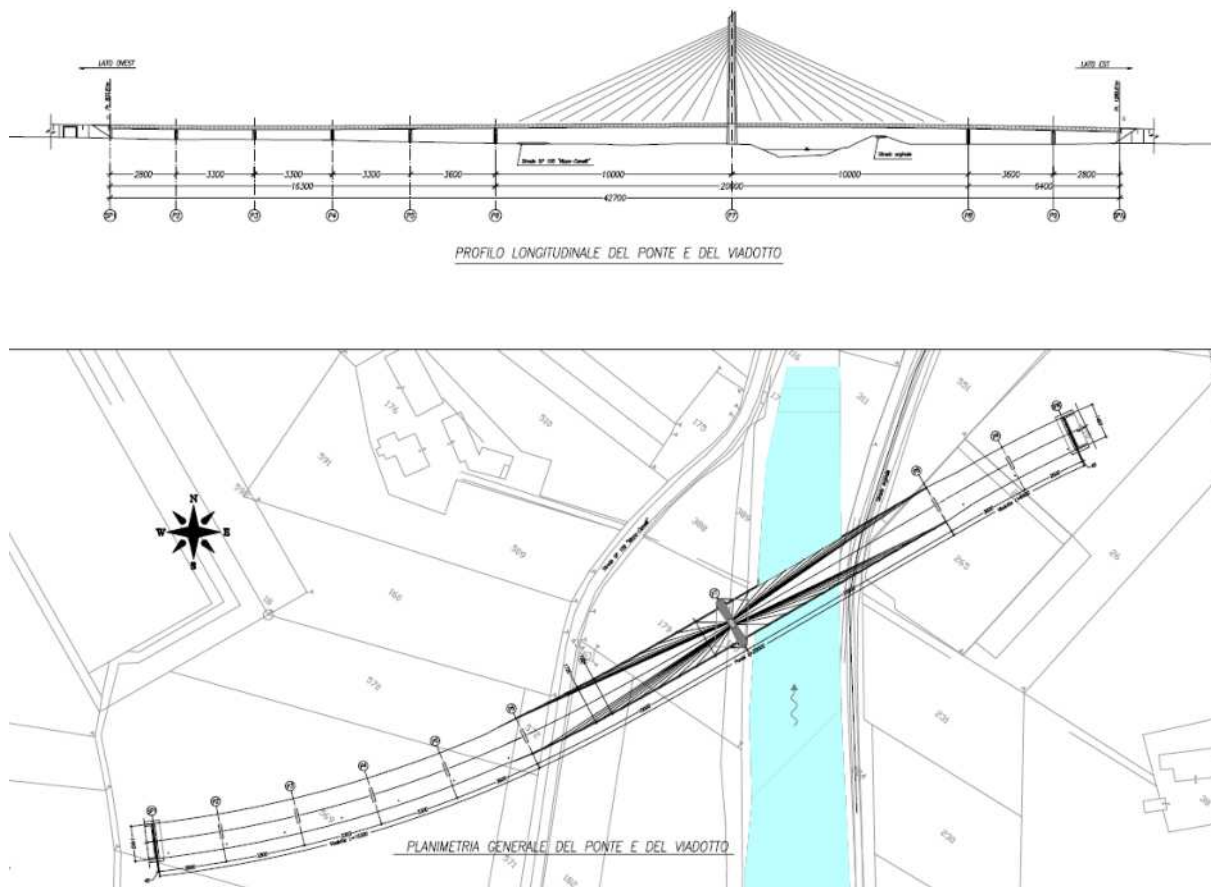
Assieme del ponte e dei viadotti: profilo longitudinale e pianta
